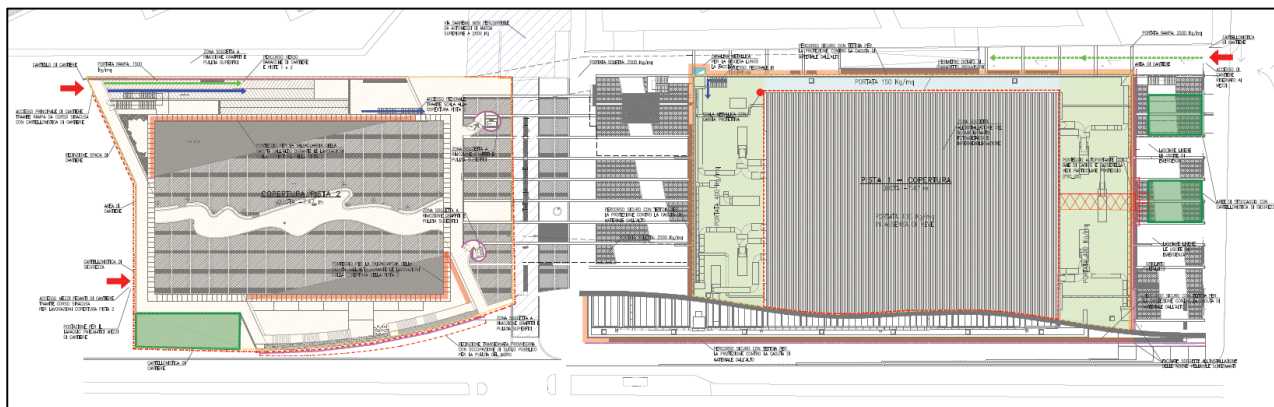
Stralcio planimetria di cantiere (si veda l'allegato B del PSC)
